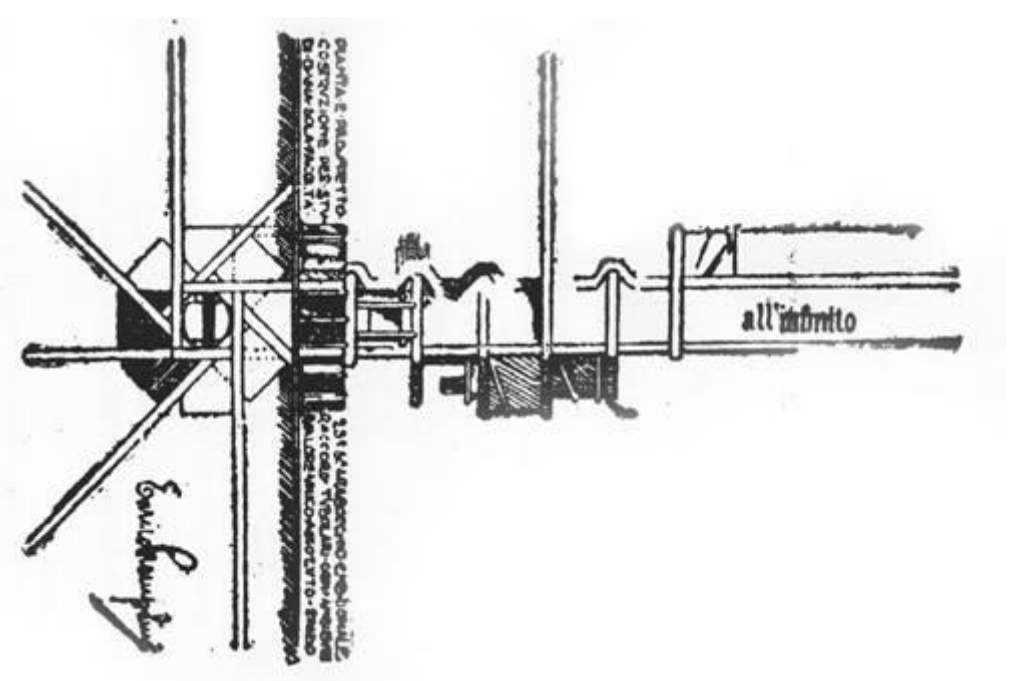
E. Prampolini, Pianta e prospetto costruzione per
